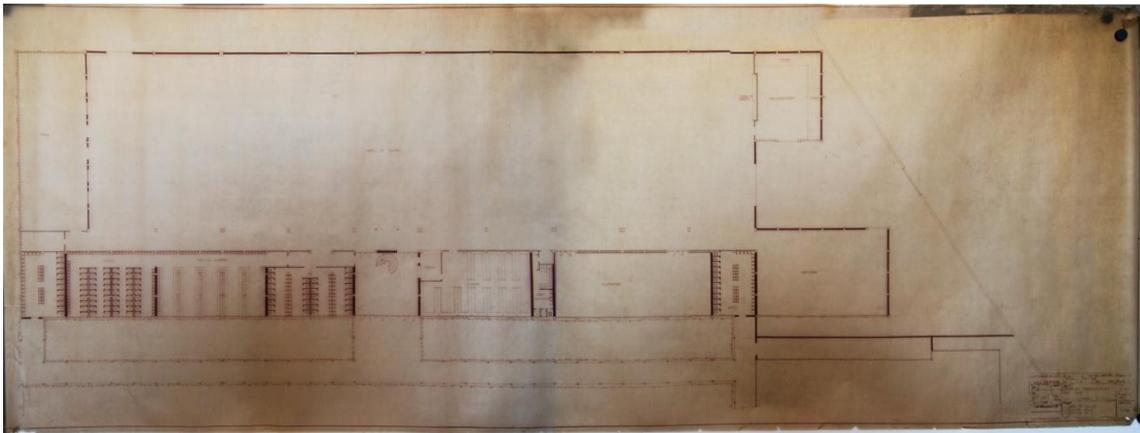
Plano planta baja taller. *Archivo Escuelas San José.
